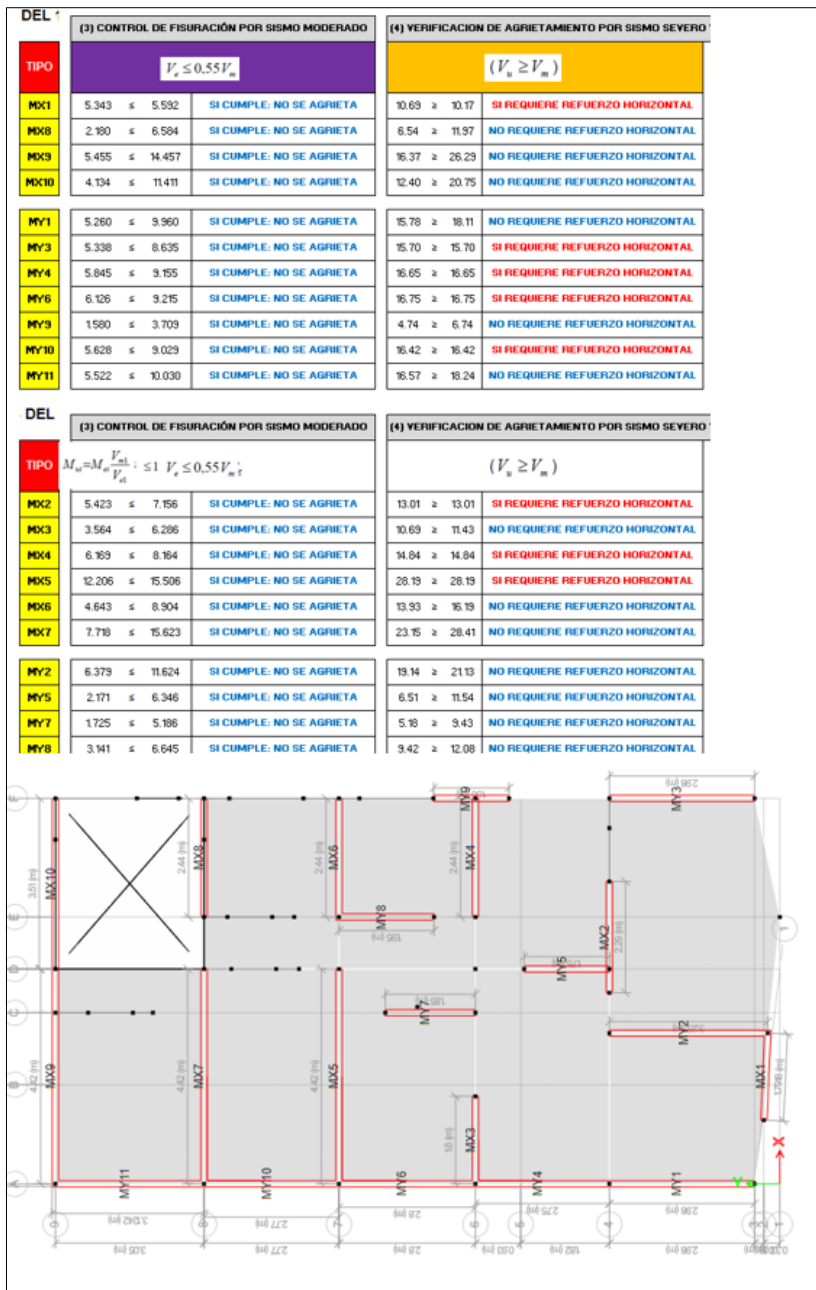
Control de fisuración por sismo severo y moderado de la vivienda 06
